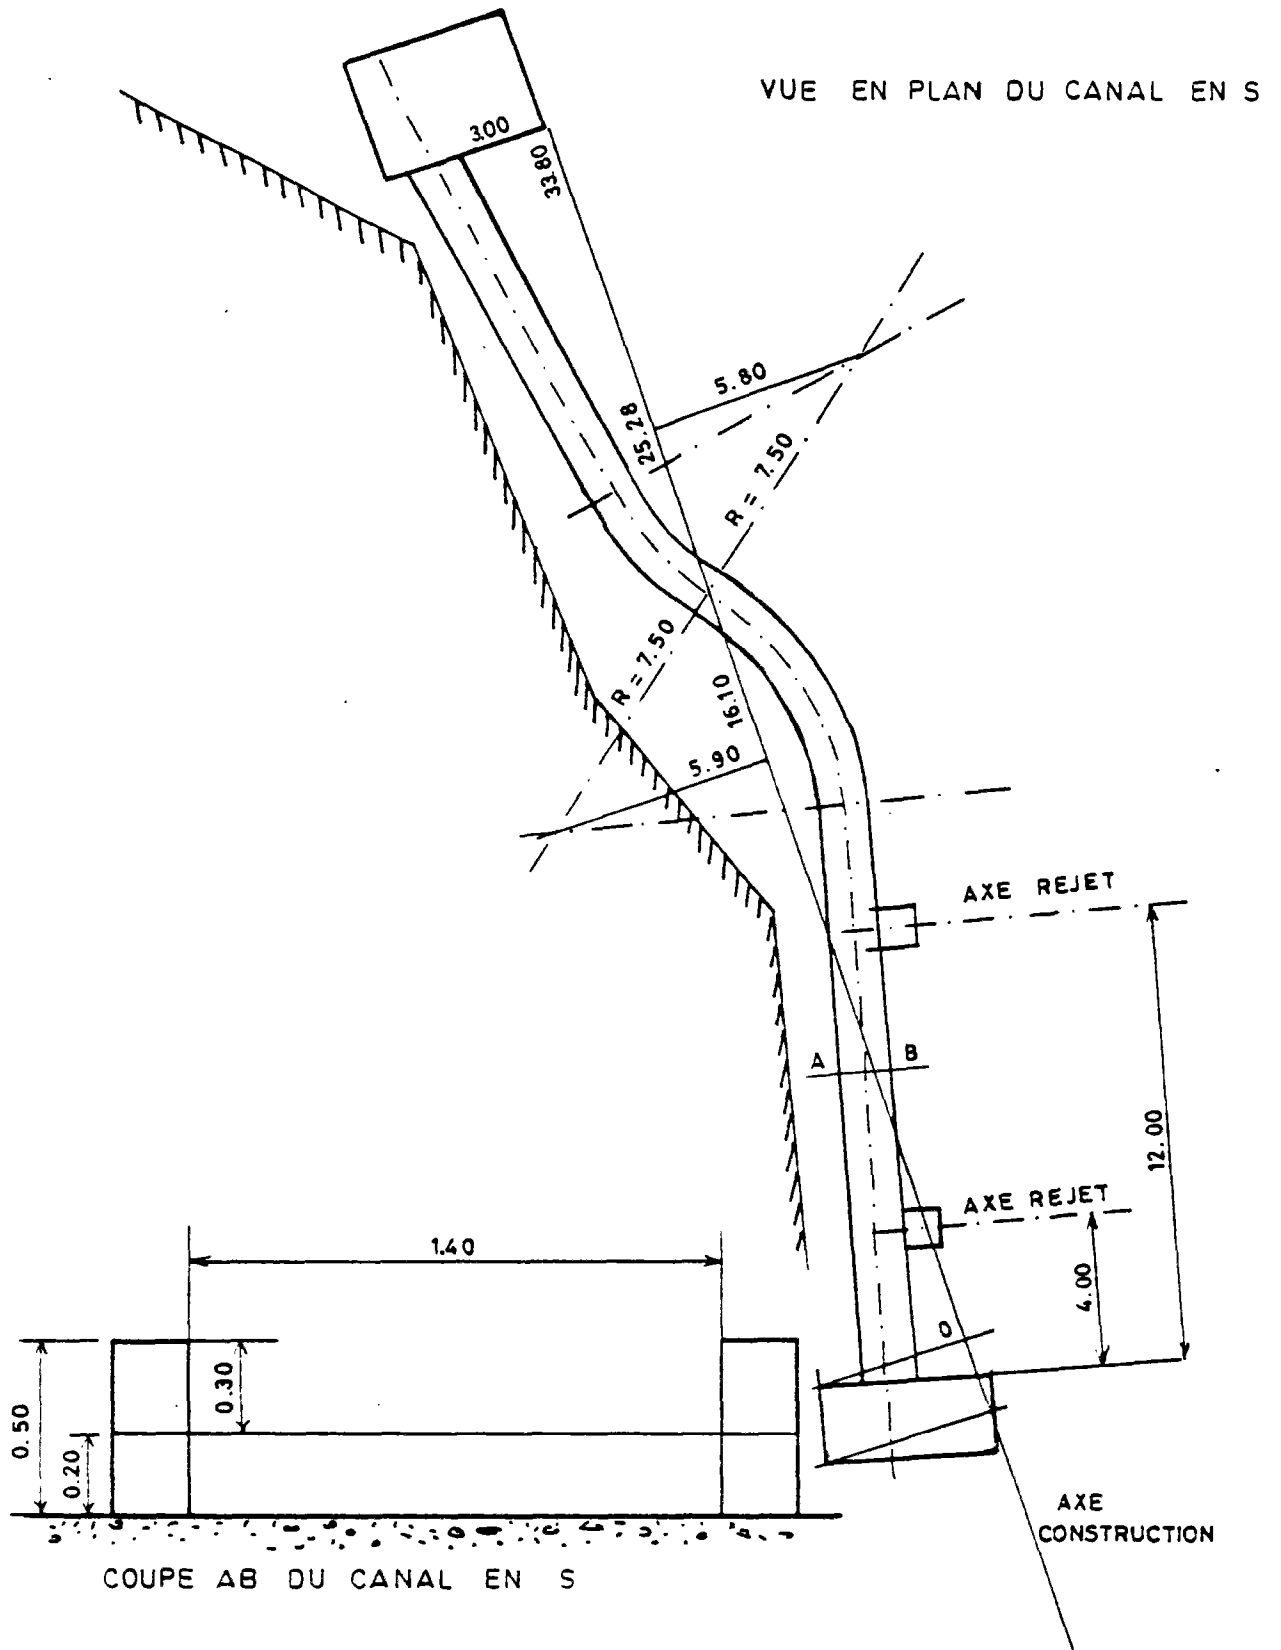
GEOMETRIE EN PLAN DU CANAL EN S
